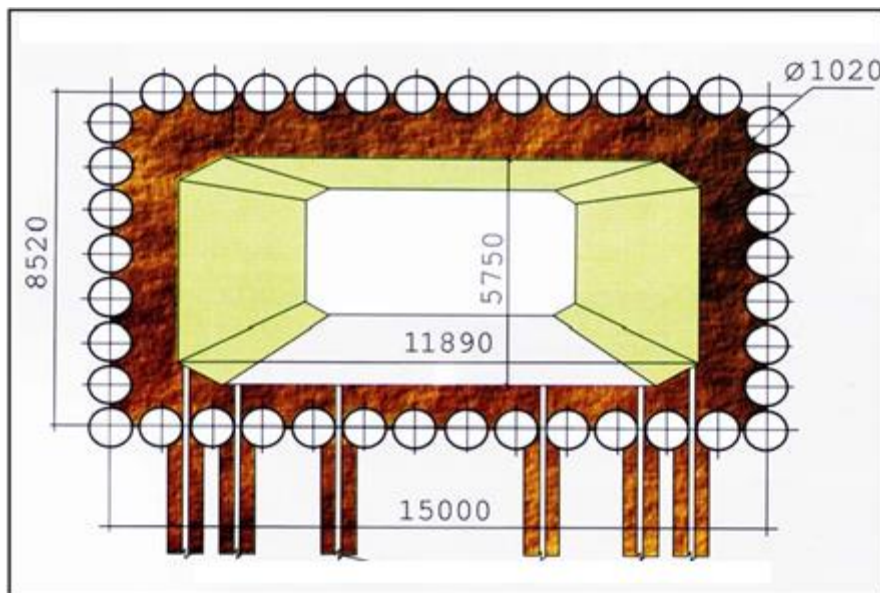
Екран з металевих труб $d1020$ мм та зміцнення ґрунту в основі лотка тунелю ґрунтоцементними палями
